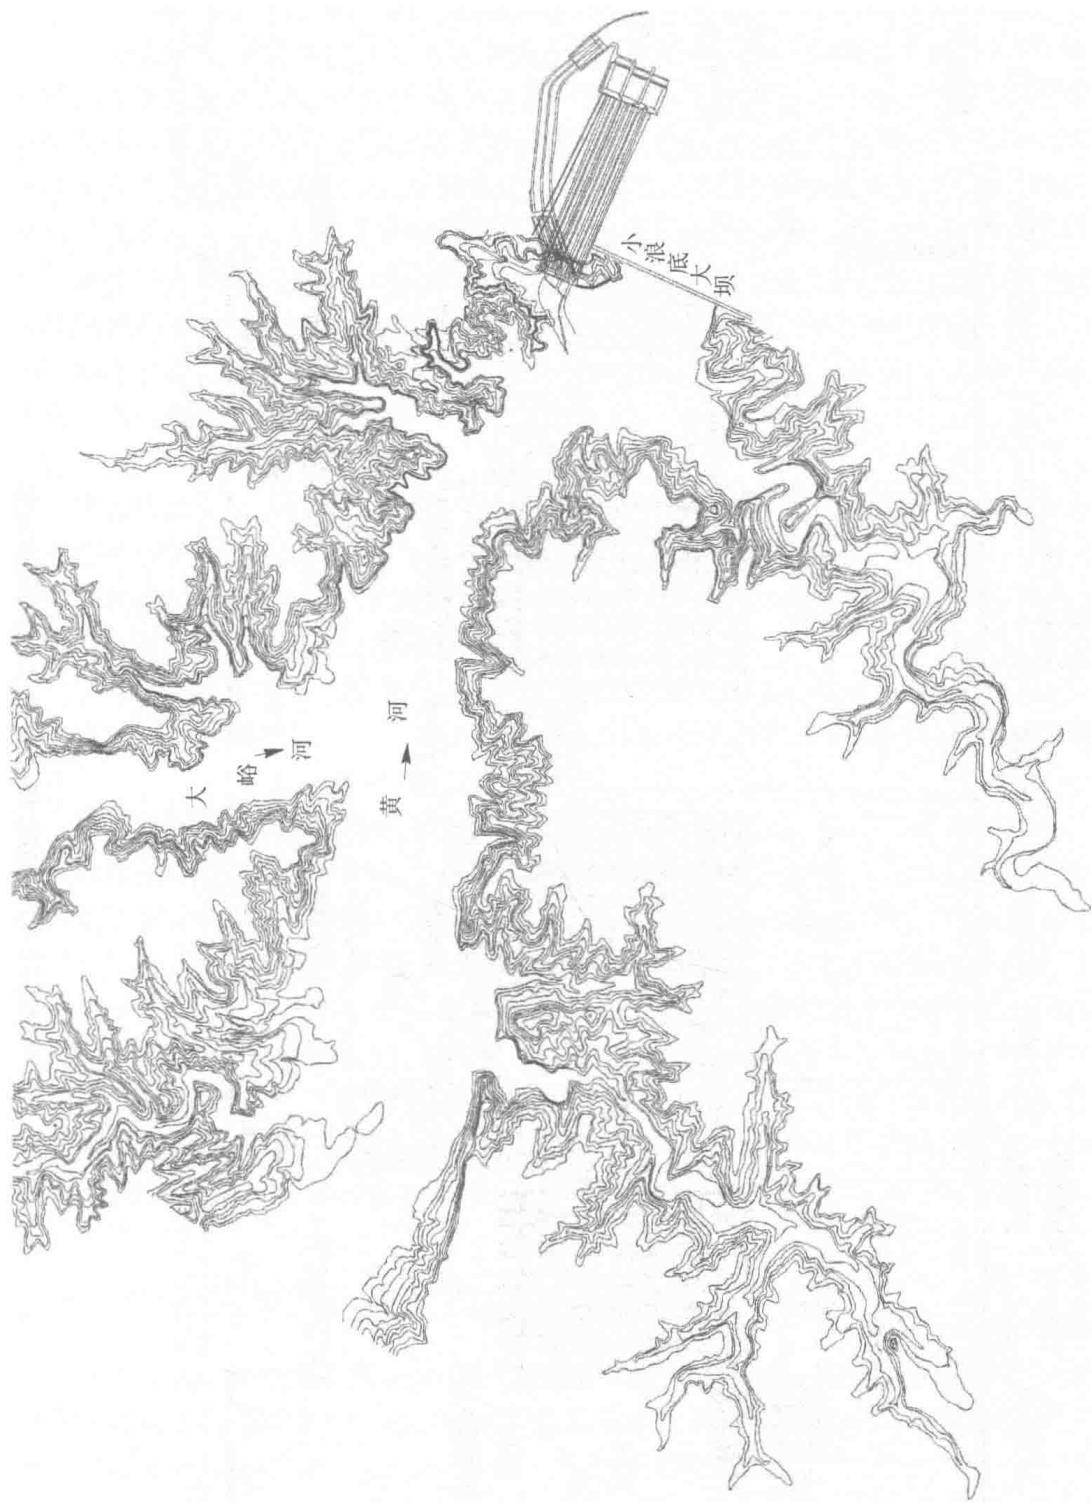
小浪底水利枢纽进水塔群平面布置图
